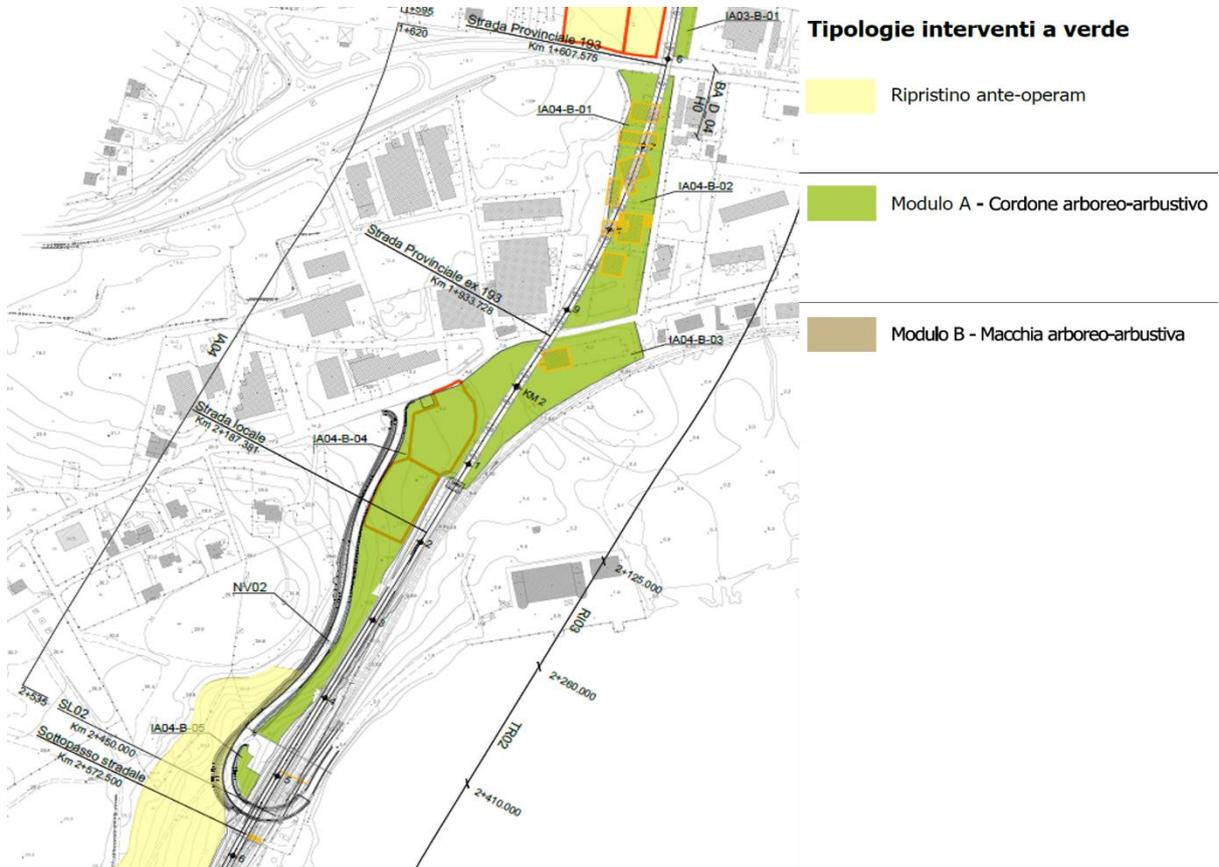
Opere a verde previste nell'ambito del progetto di Bypass
